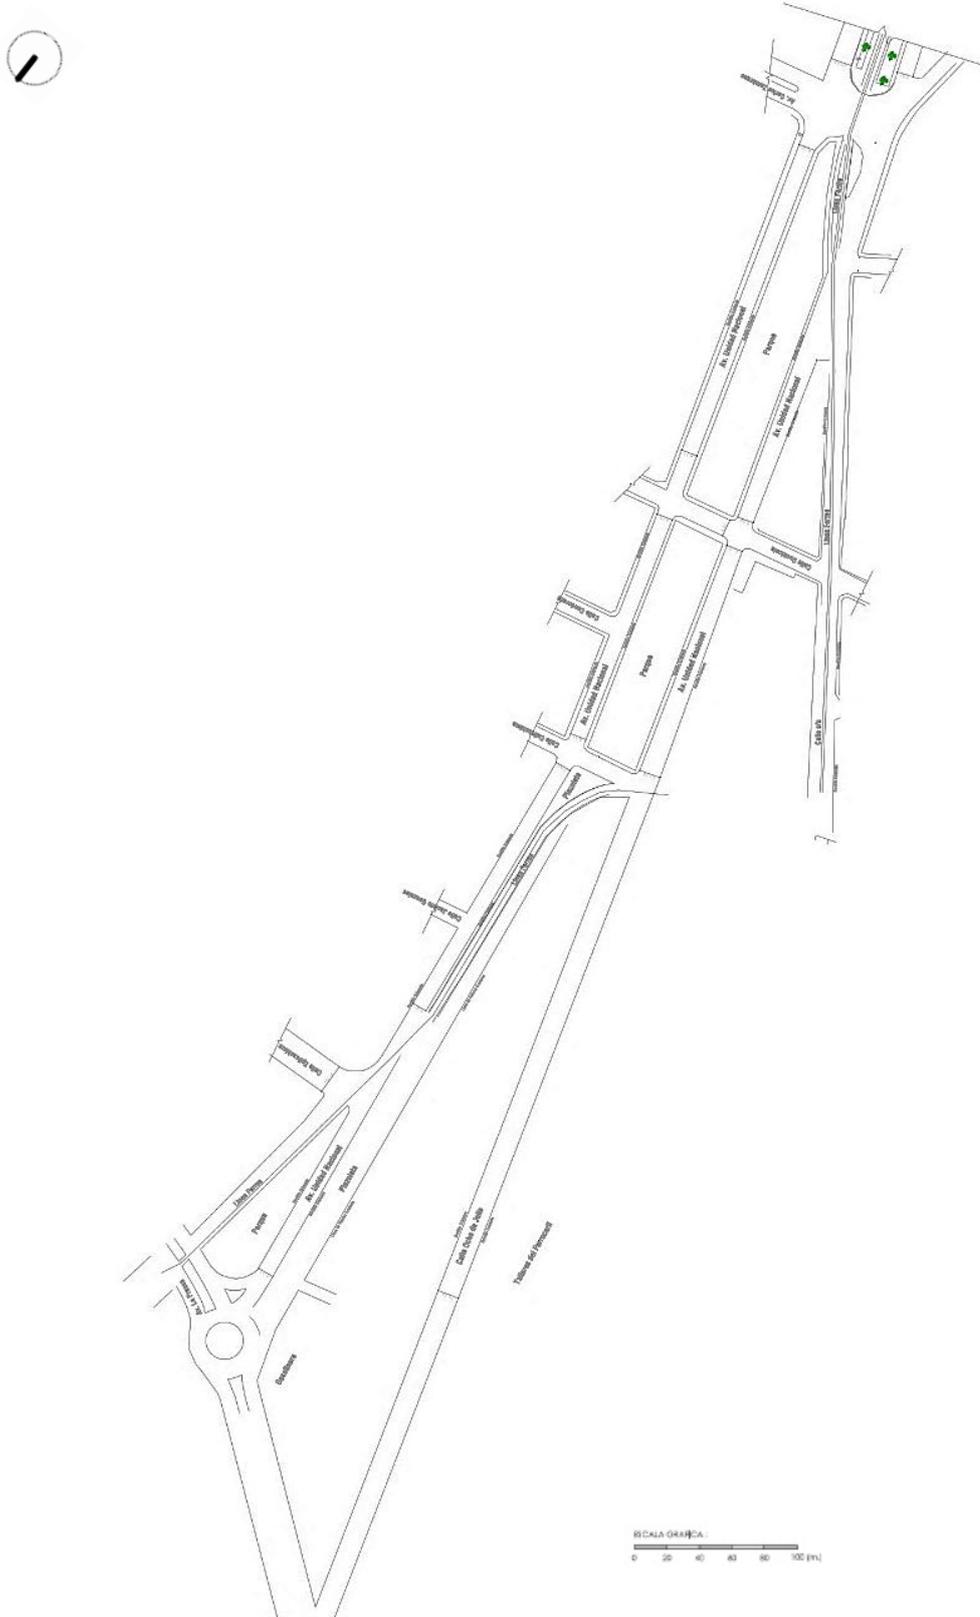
Levantamiento topográfico de área a intervenir.
